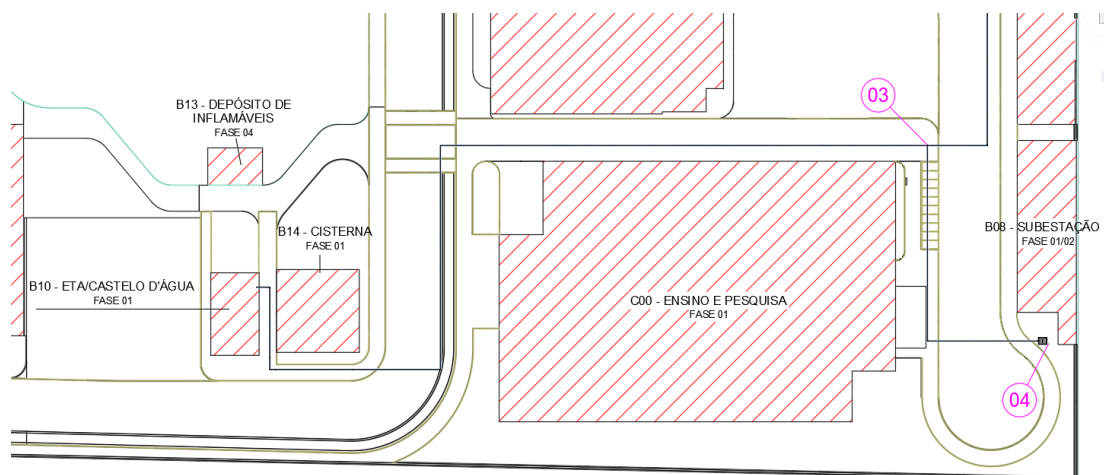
Planta trecho (Castelo d'água / Bloco B08)
